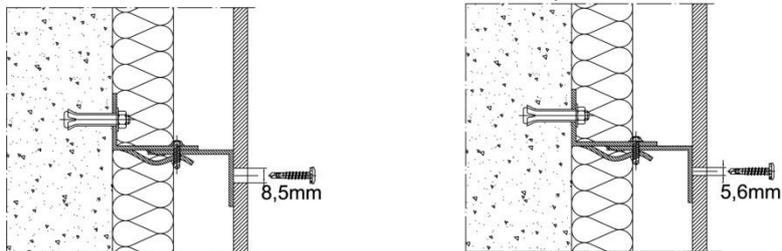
SUBESTRUCTURA METÁLICA (REMACHE AP16)
